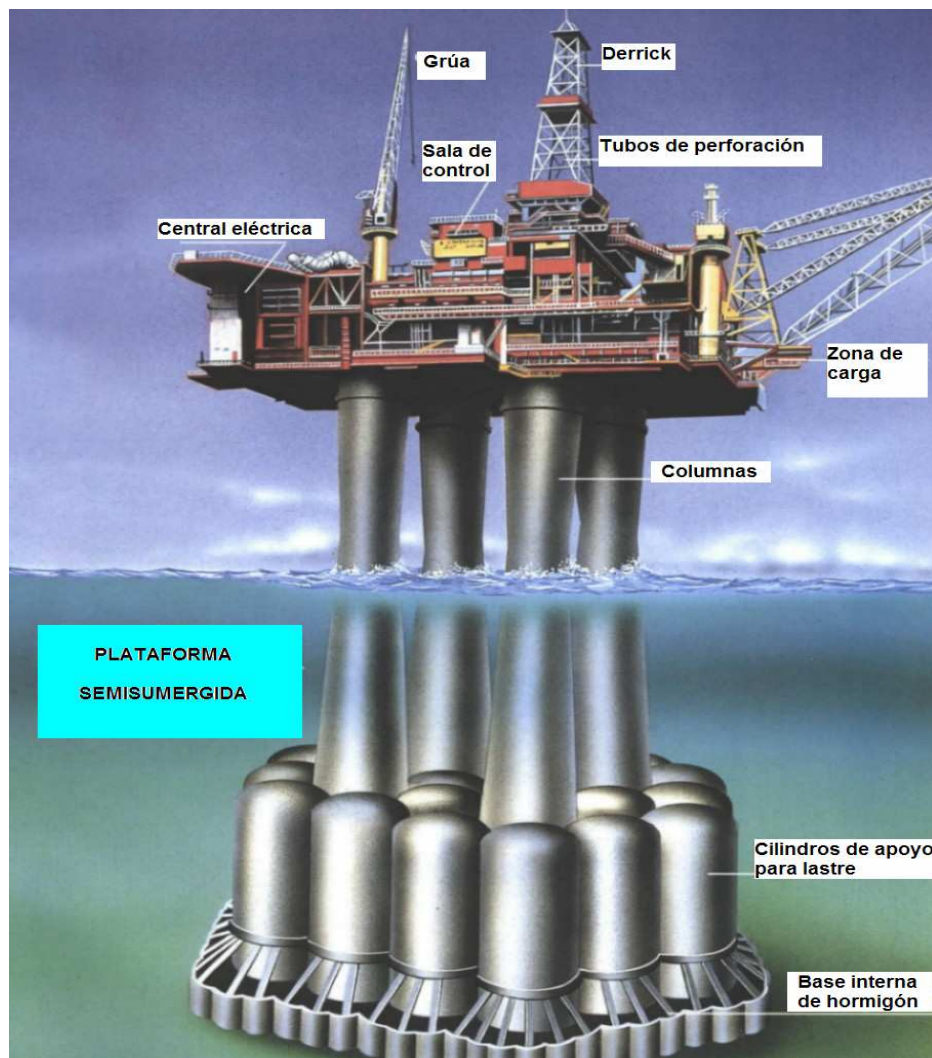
Planta de extracción petrolífera submarina (Fuente: Elaboración propia)
